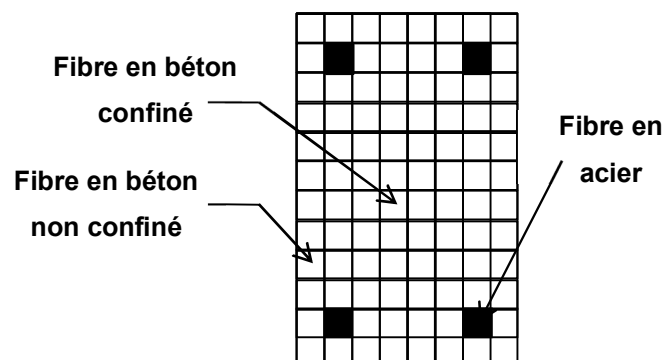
7: Discretisation en fibres d'une section en béton armé.
